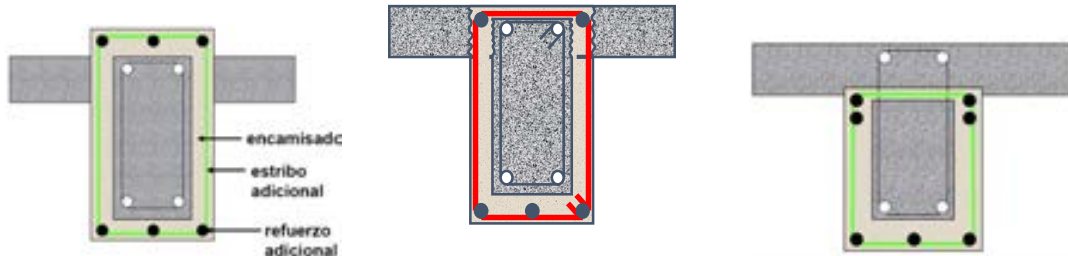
Posibles configuraciones de encamisado de vigas con concreto (Terán A., 2009)
